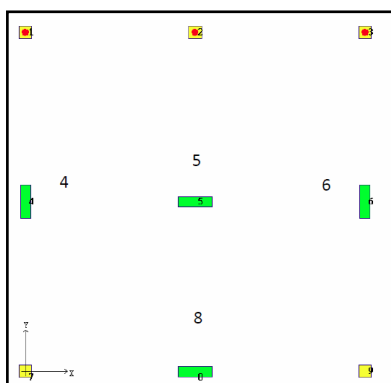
Pianta dell'edificio dell'esempio 1 tratto da /12/. Si osservano le "pareti" 80x20 cmq.
